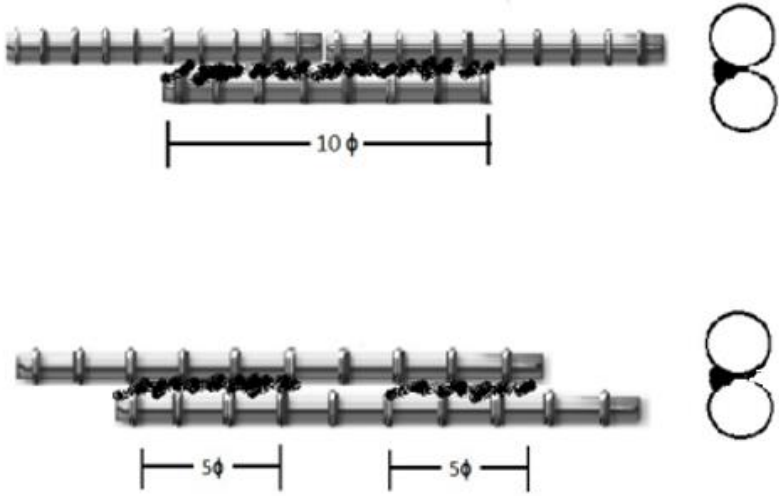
Longitud de empalme para soldadura por ambos lados [2].
